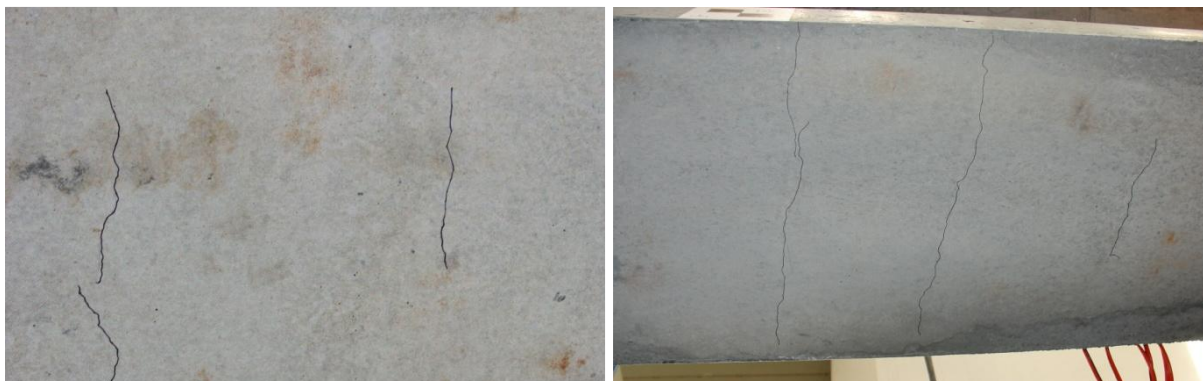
Padrão de fissuração na face inferior da viga para um deslocamento do actuador de 100 mm
